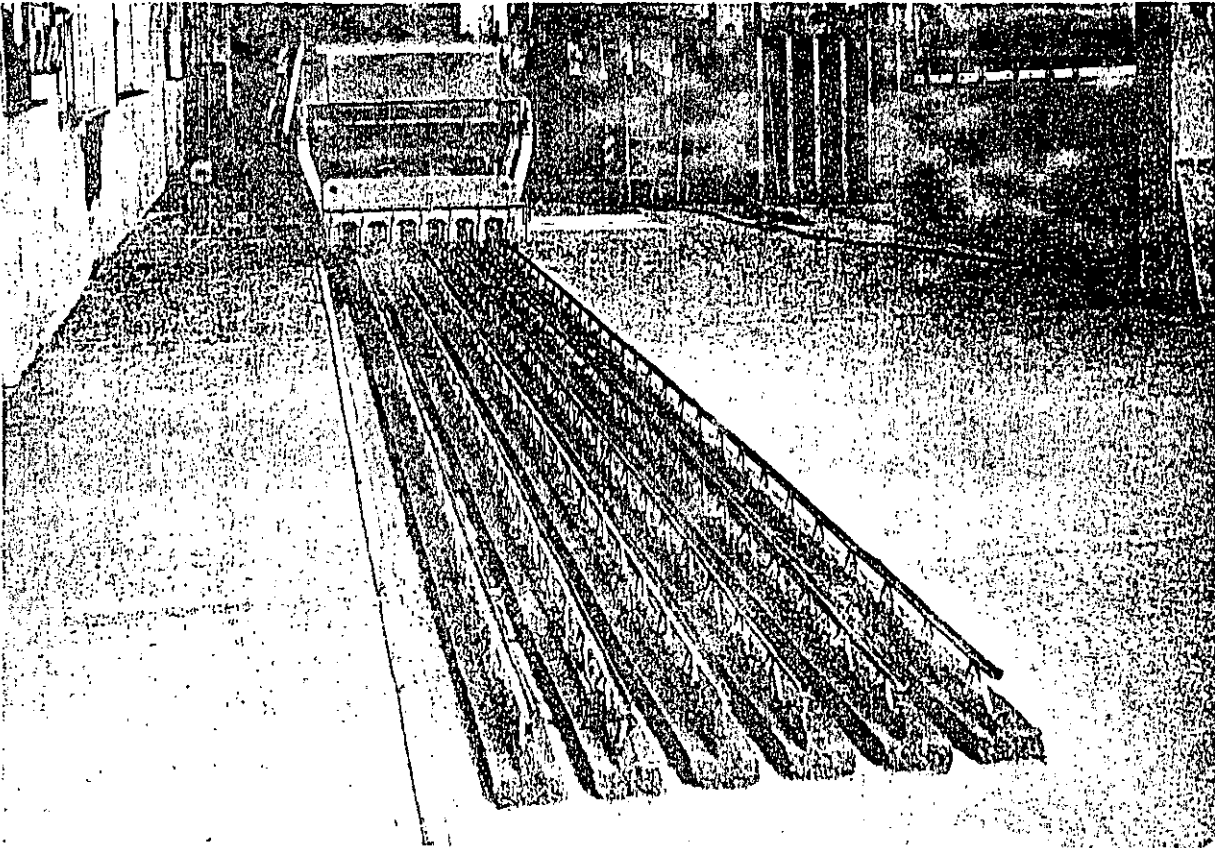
Máquina extrusora para la producción continua de viguetas semi-prefabricadas. Marca Weiler
